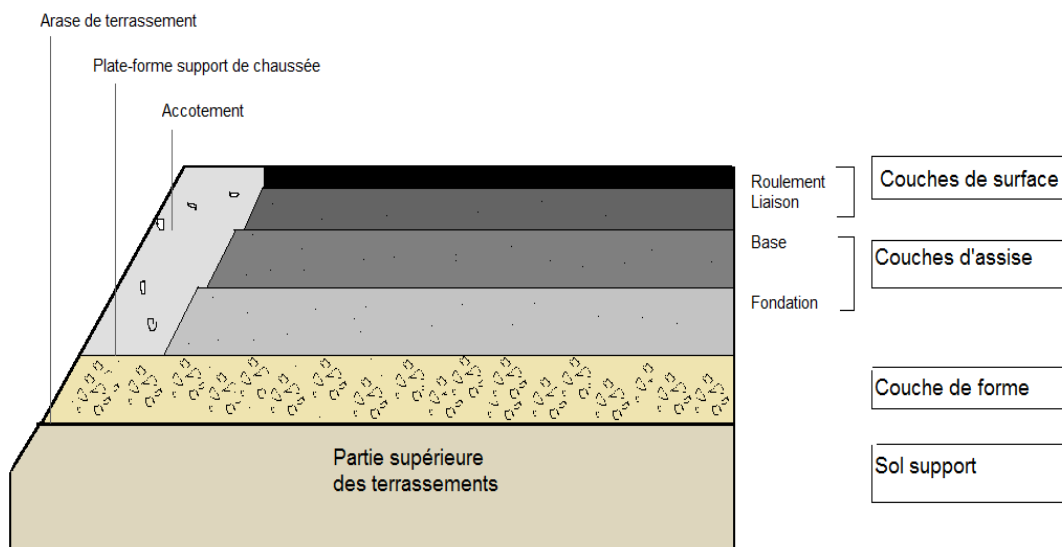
Constitution d'une chaussée (Faure, 1997).
